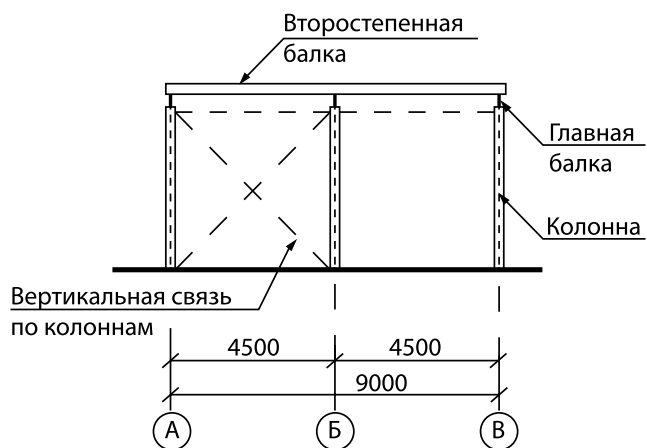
Разрез 2-2 по несущим конструкциям каркаса
